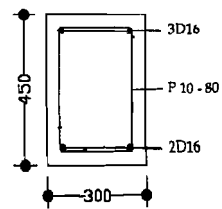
Detail Tulangan Balok Induk BA1-BA3
